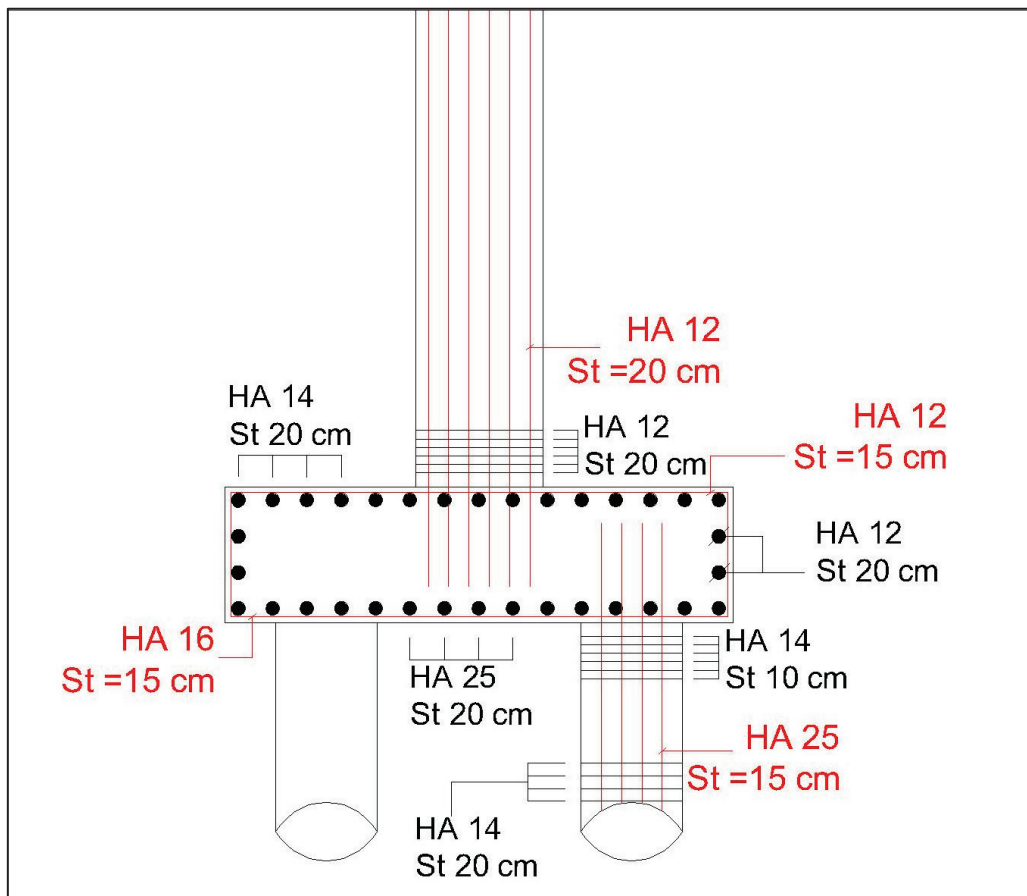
Croquis du ferrailage de la pile, et sa fondation
